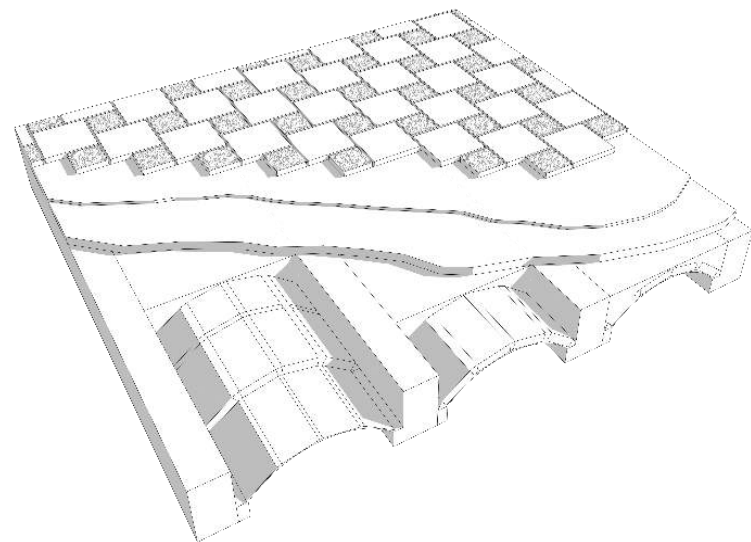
Detalle constructivo Forjado. Autor Propio. 2015
